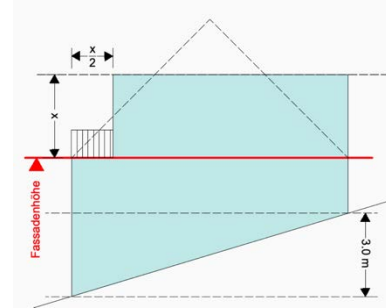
Fassadenbündiges Attikageschoss ohne Dachaufbauten (Art. 18 Abs. 2 neuBZO)
